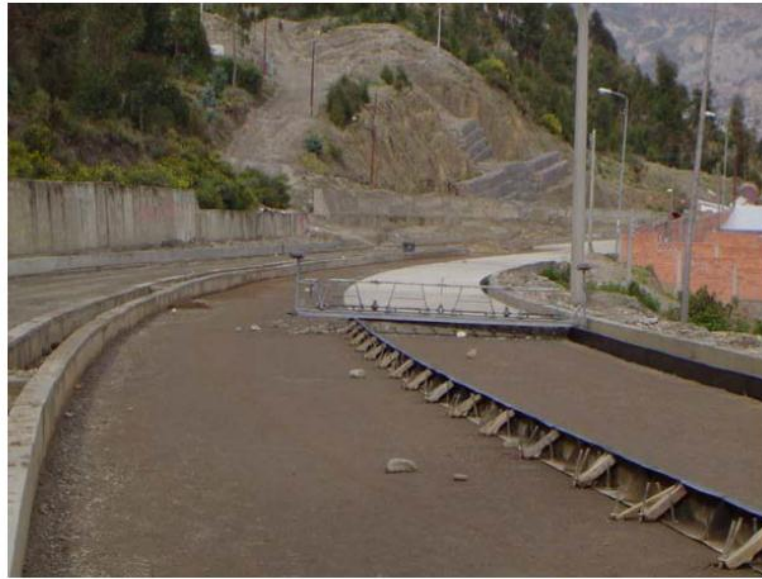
Junta transversal de construcción debida a fin de día de pavimentación. Los moldes indican la pavimentación por carriles.
